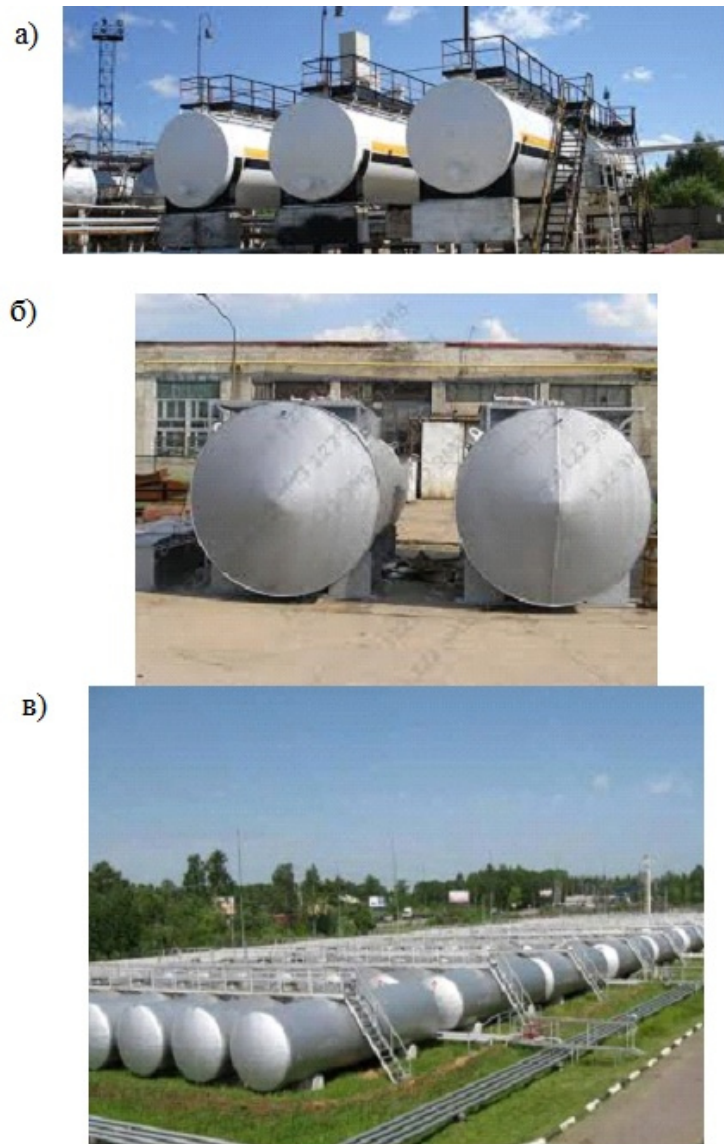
Циліндричні резервуари з різними типами днищ:
